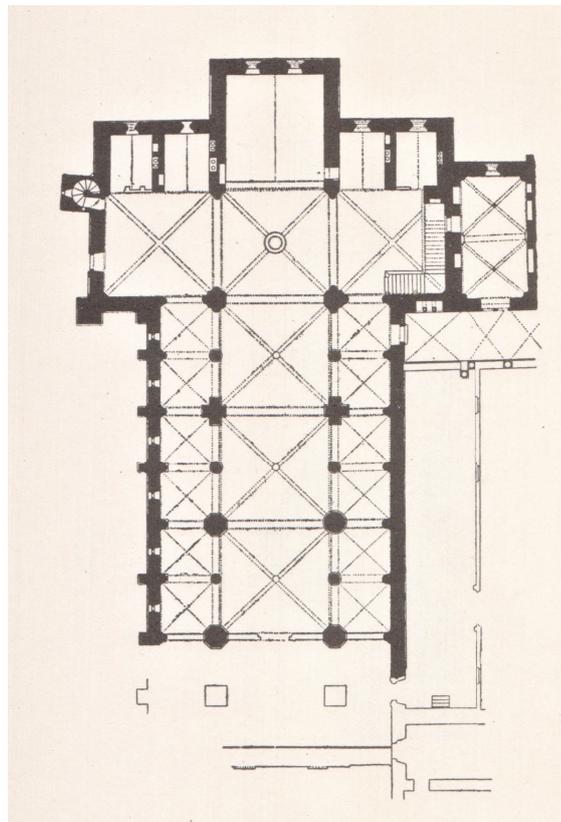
Piero Molli, Planimetria della chiesa (in LUGANO, 1987)
